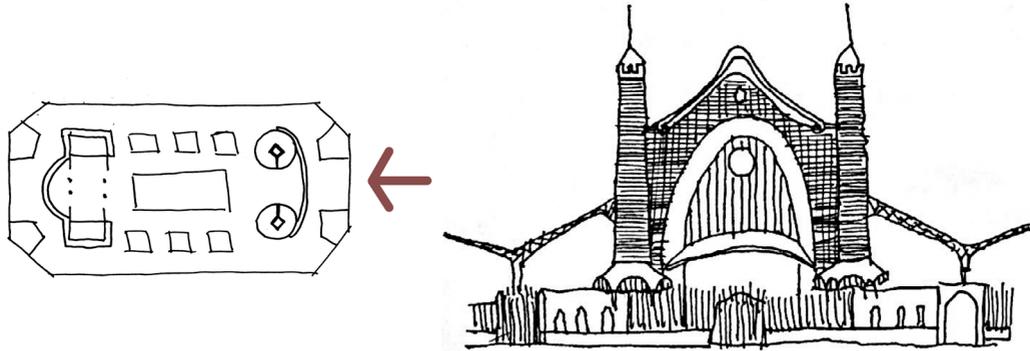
Esquema de la fachada de Conde Salvatierra
